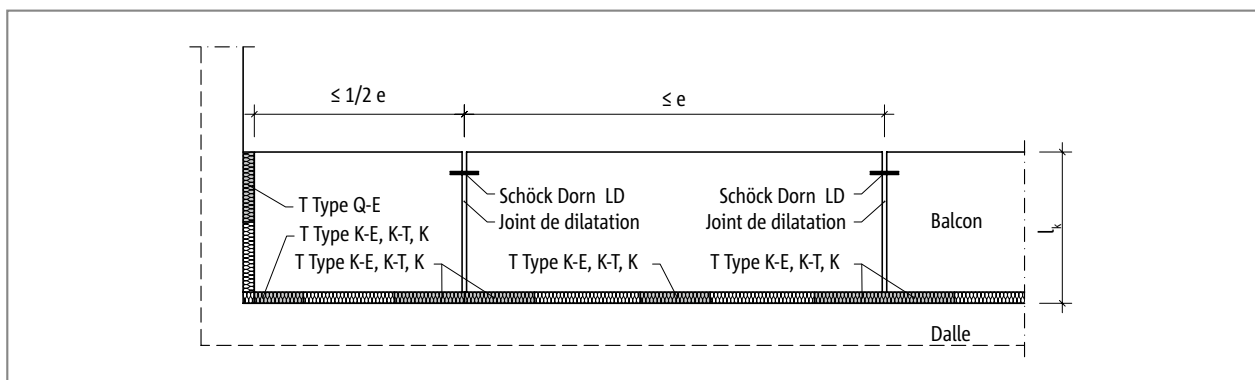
Schöck Isokorb® T Type K-E, K-T : Disposition des joints de dilatation
